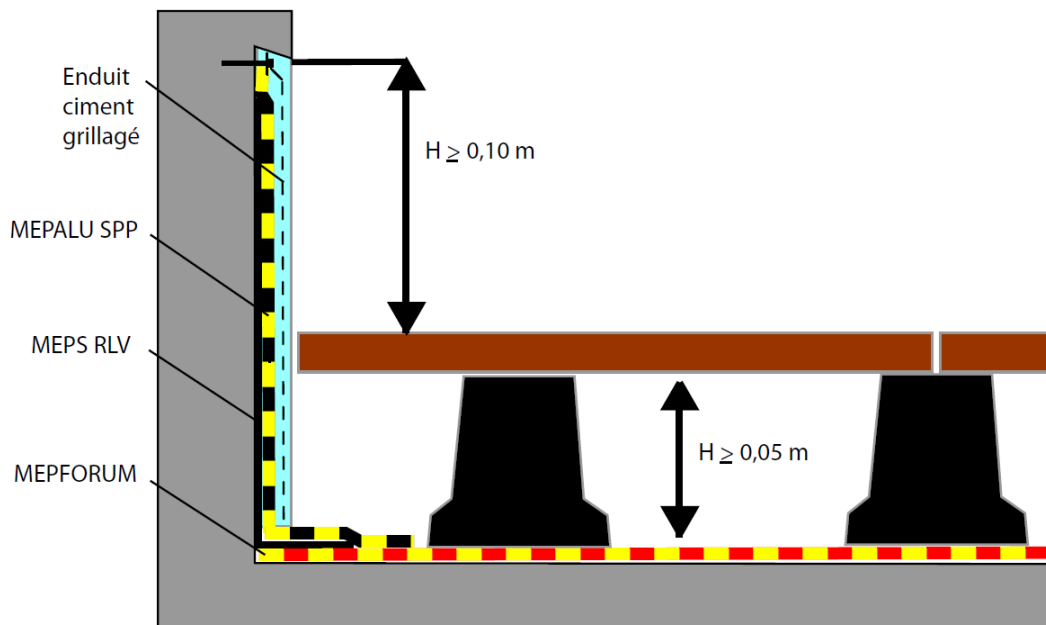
Exemple avec tête de relevé au-dessus du niveau fini de la protection directe par dalles sur plots
